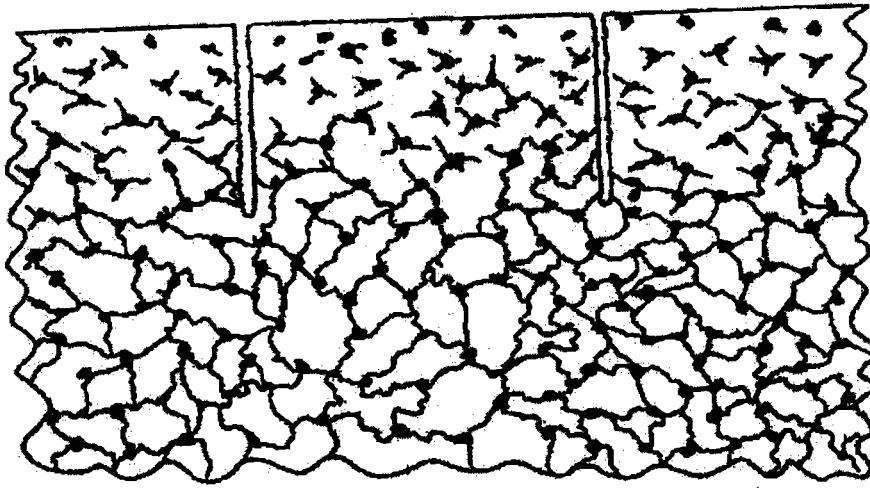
鹼質與粒料反應在平面混凝土所造成典型裂縫型式
